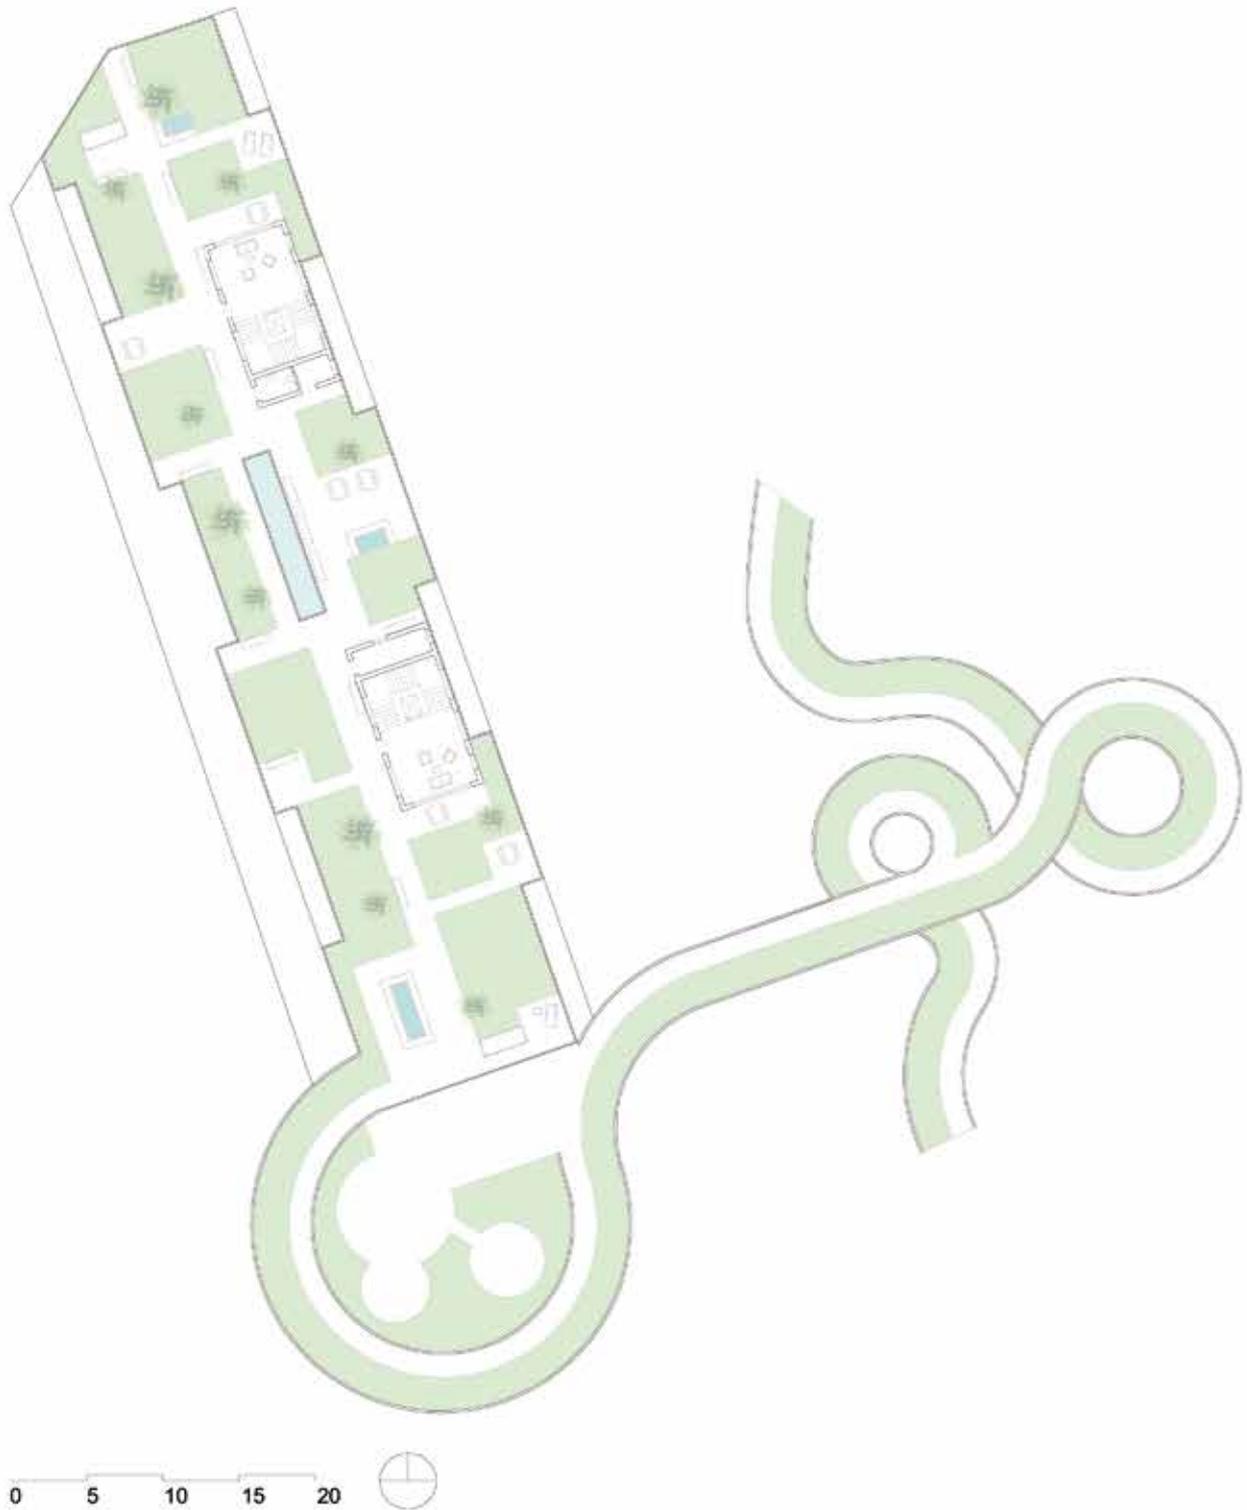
Übersichtsplan und Grundriss M 1:500
